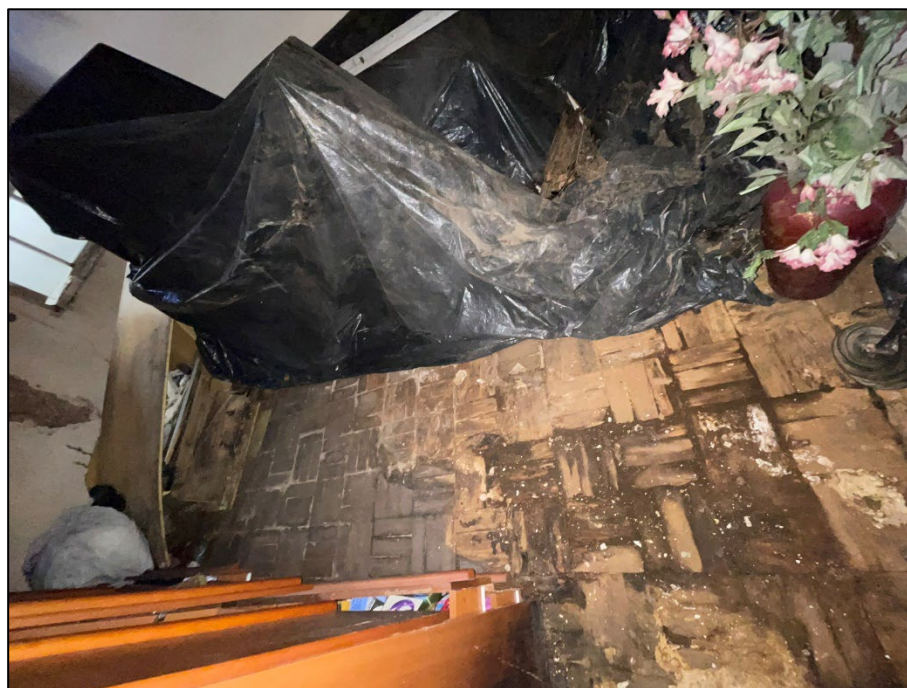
Rua Riachuelo, n.º 88 – Piso do Dormitório
